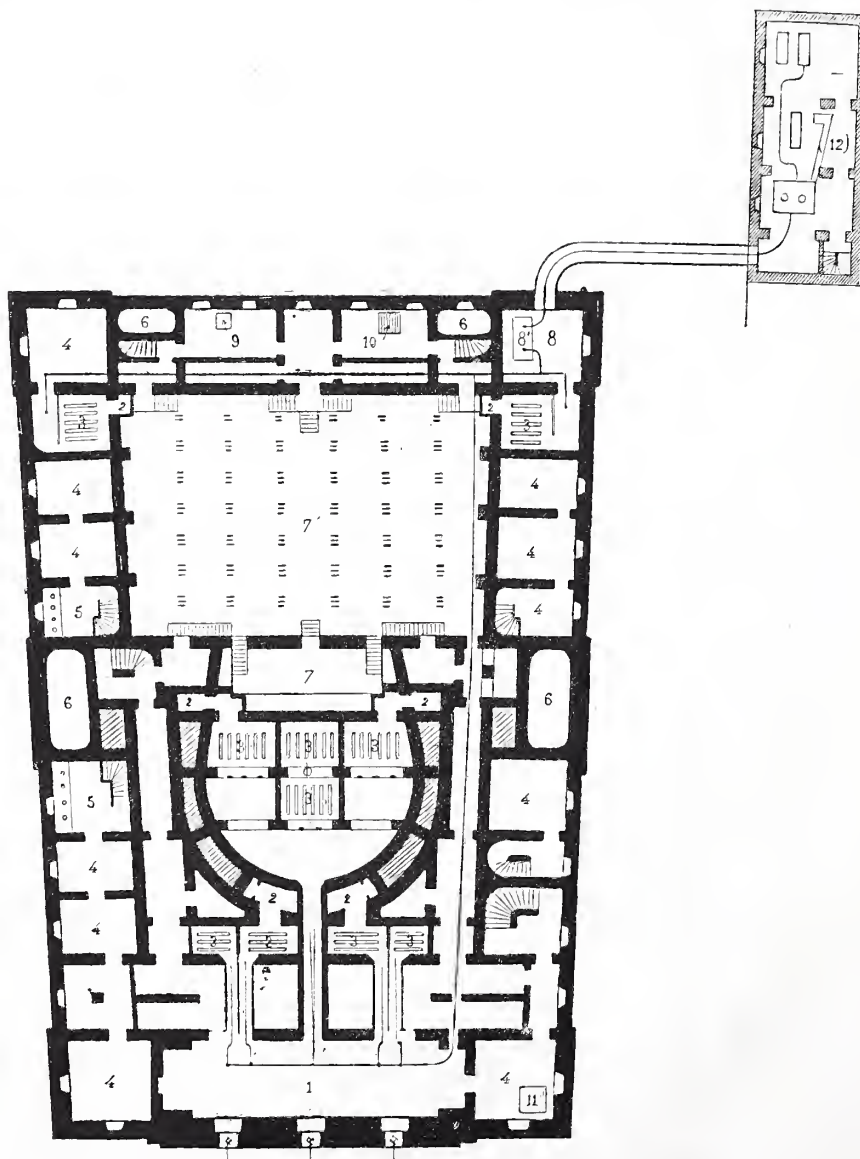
Plan du sous-sol (Échelle 0,002 p. m.)
